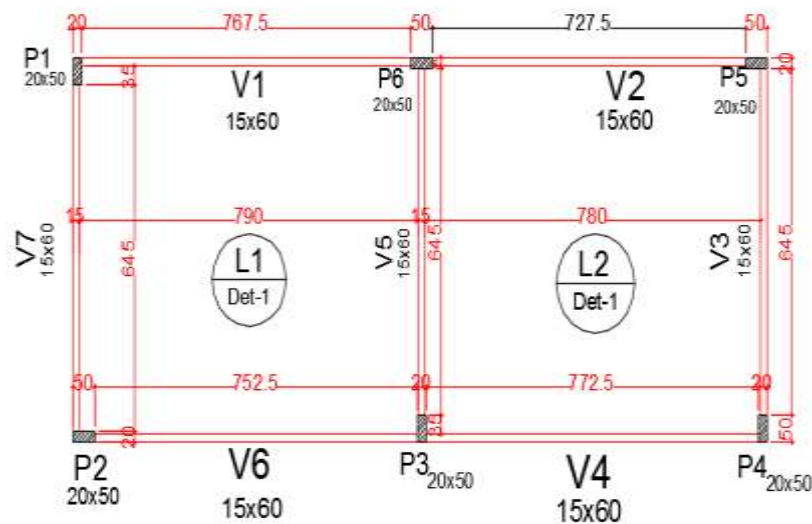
Planta de forma da estrutura fictícia em concreto armado
